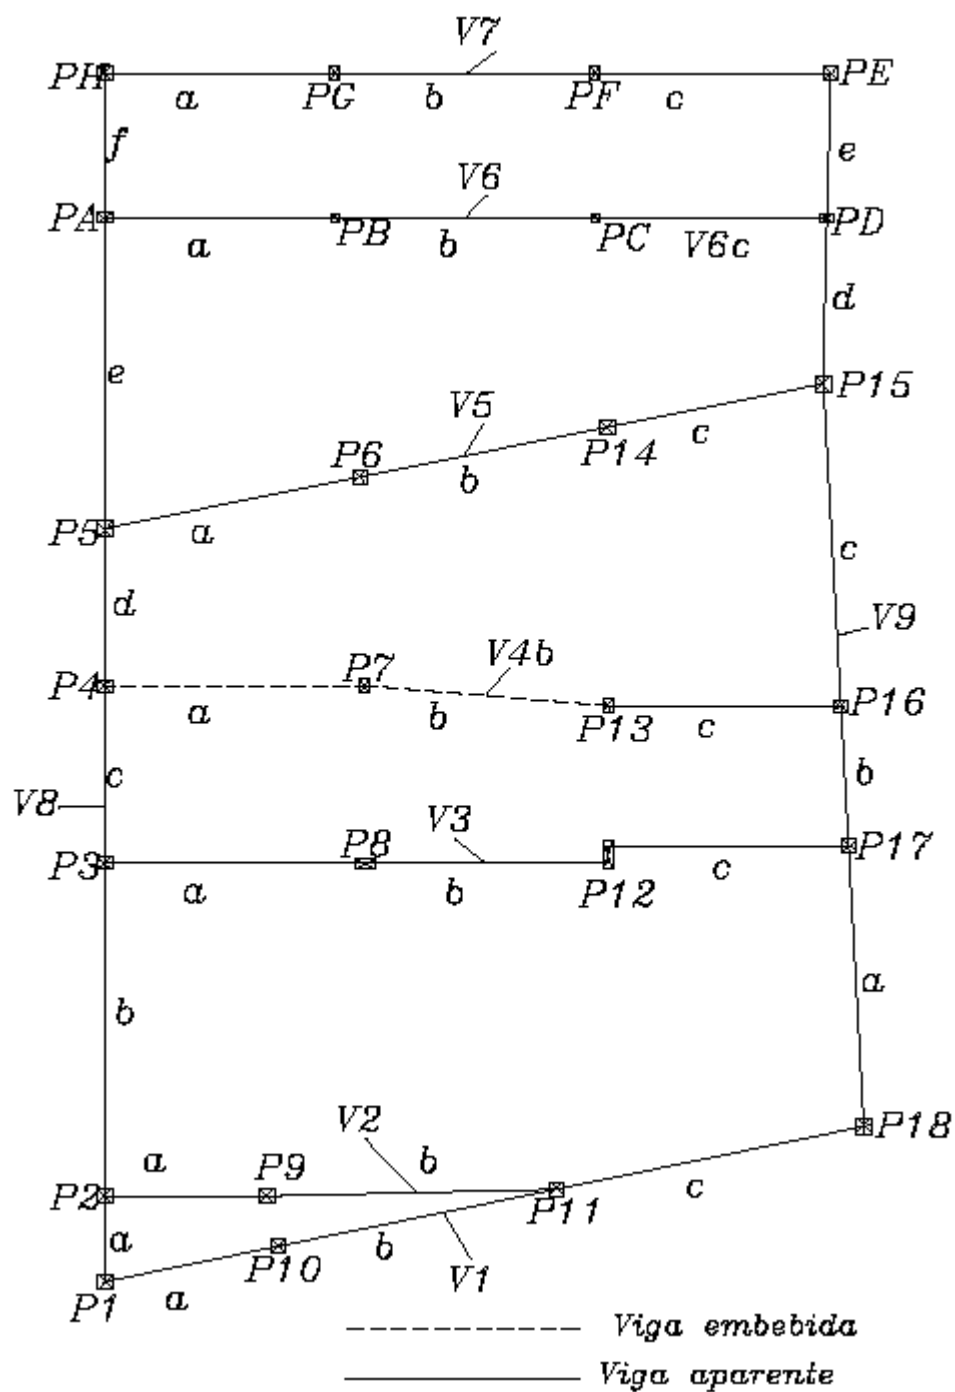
Elementos estruturais vigas e pilares (escala 1:100)
